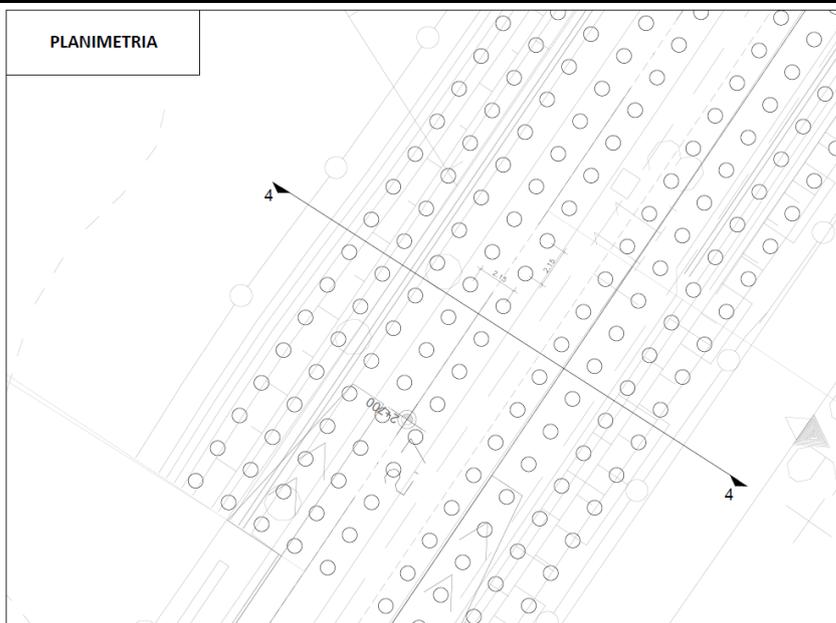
Sezione rappresentativa tratte 2+650 – 2+710 e 2+960 – 3+100 - planimetria
